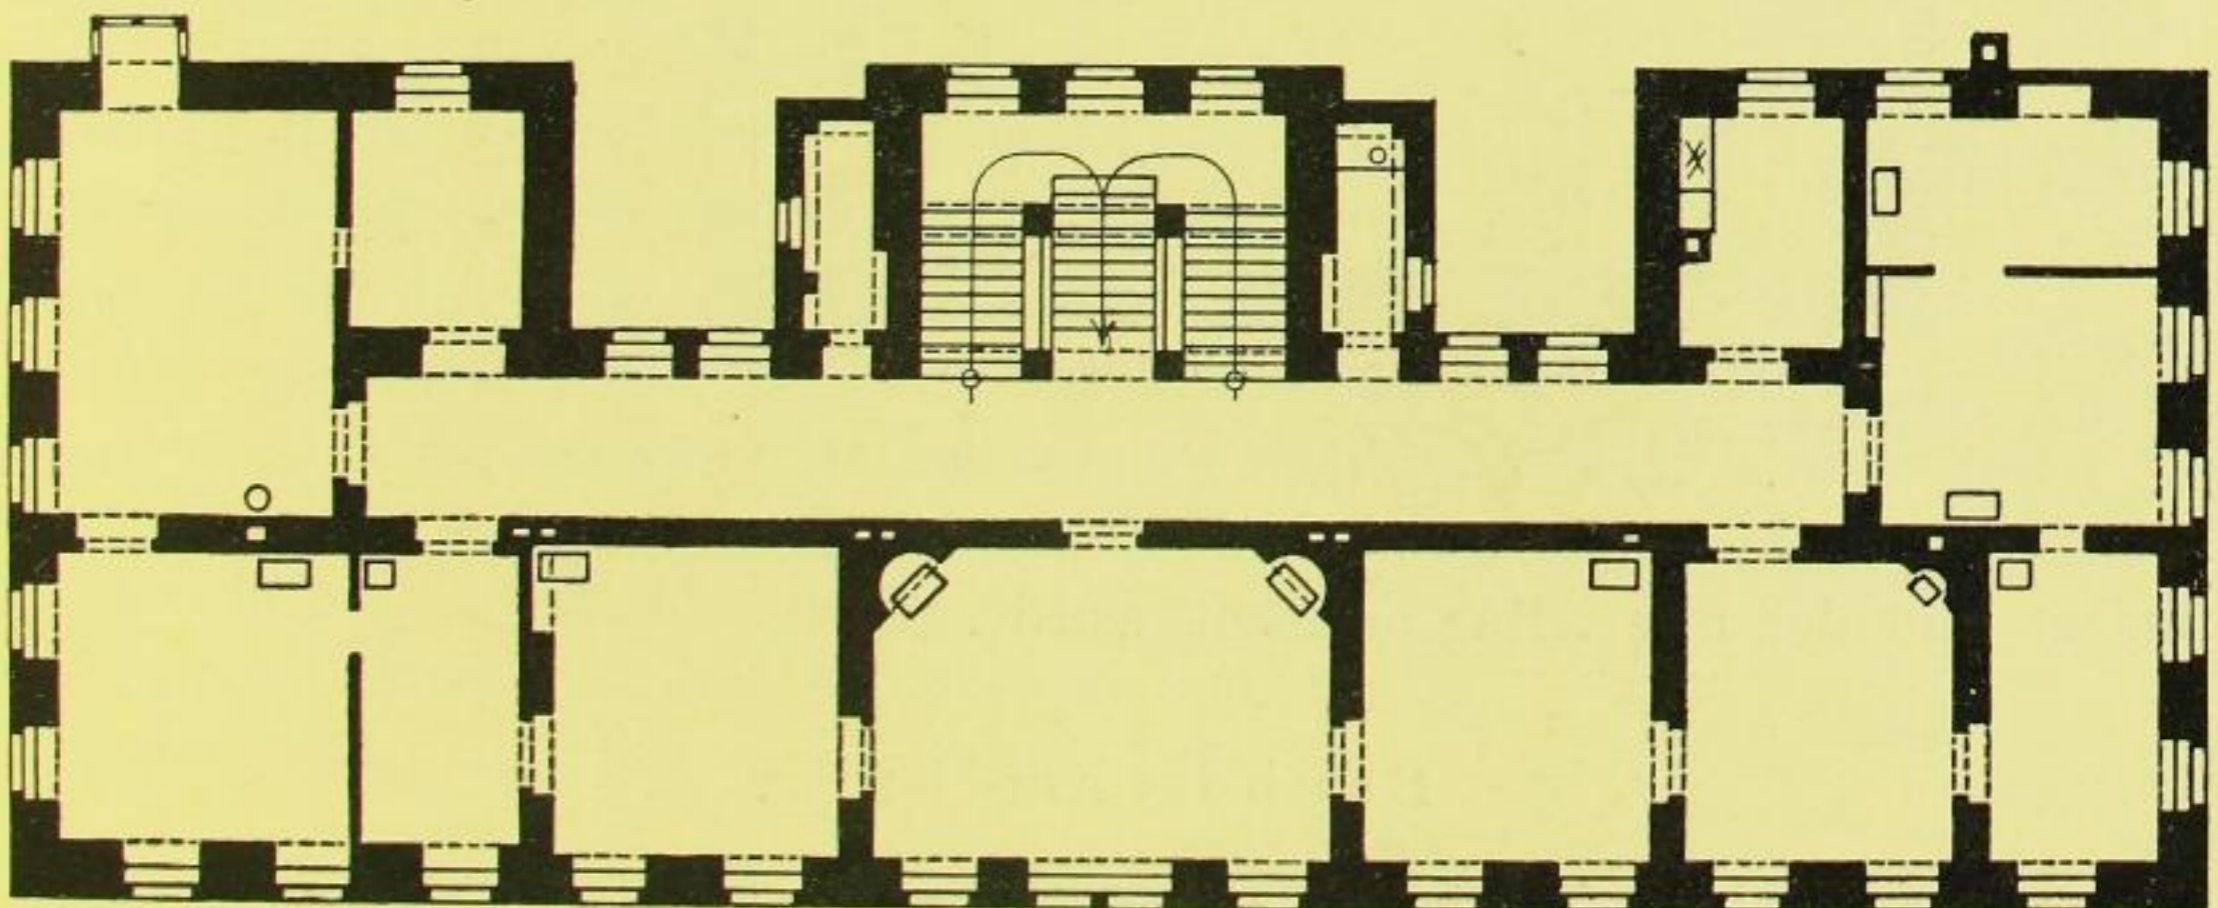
Dallwitz, Herrenhaus, Grundriß des Obergeschosses.
